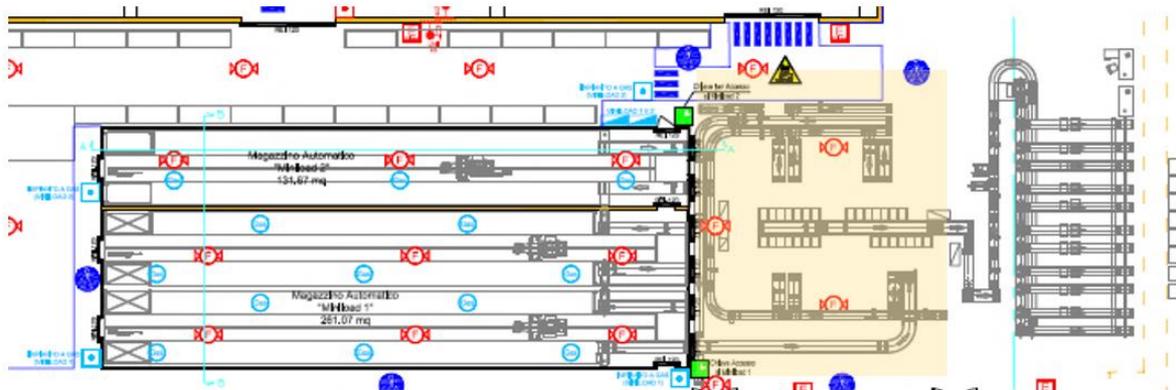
ULC - Sezione della planimetria del magazzino ULC – piano terra
